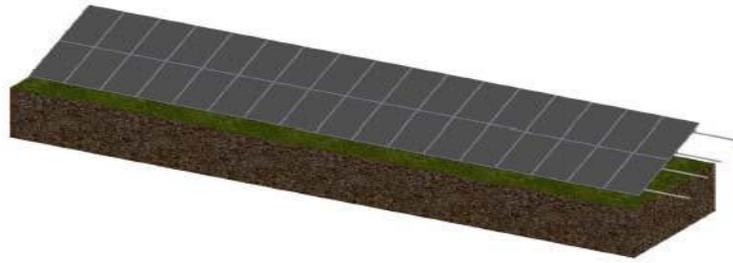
Detalle vistas en perfil de estructura de soporte fijada sobre el suelo.
